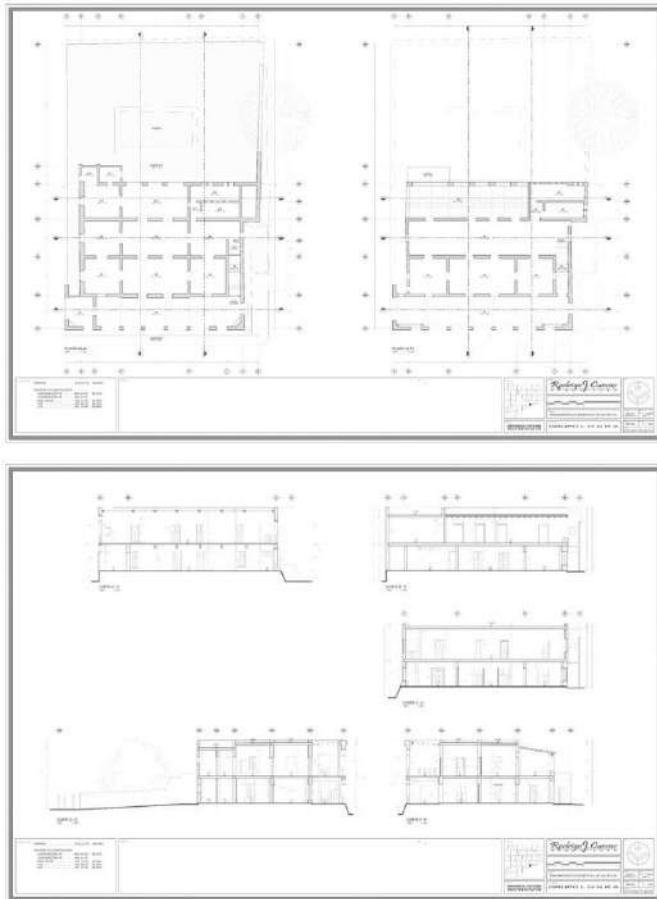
Planos del levantamiento de estado actual elaborado para este trabajo. Fuente: Elaboración propia.
